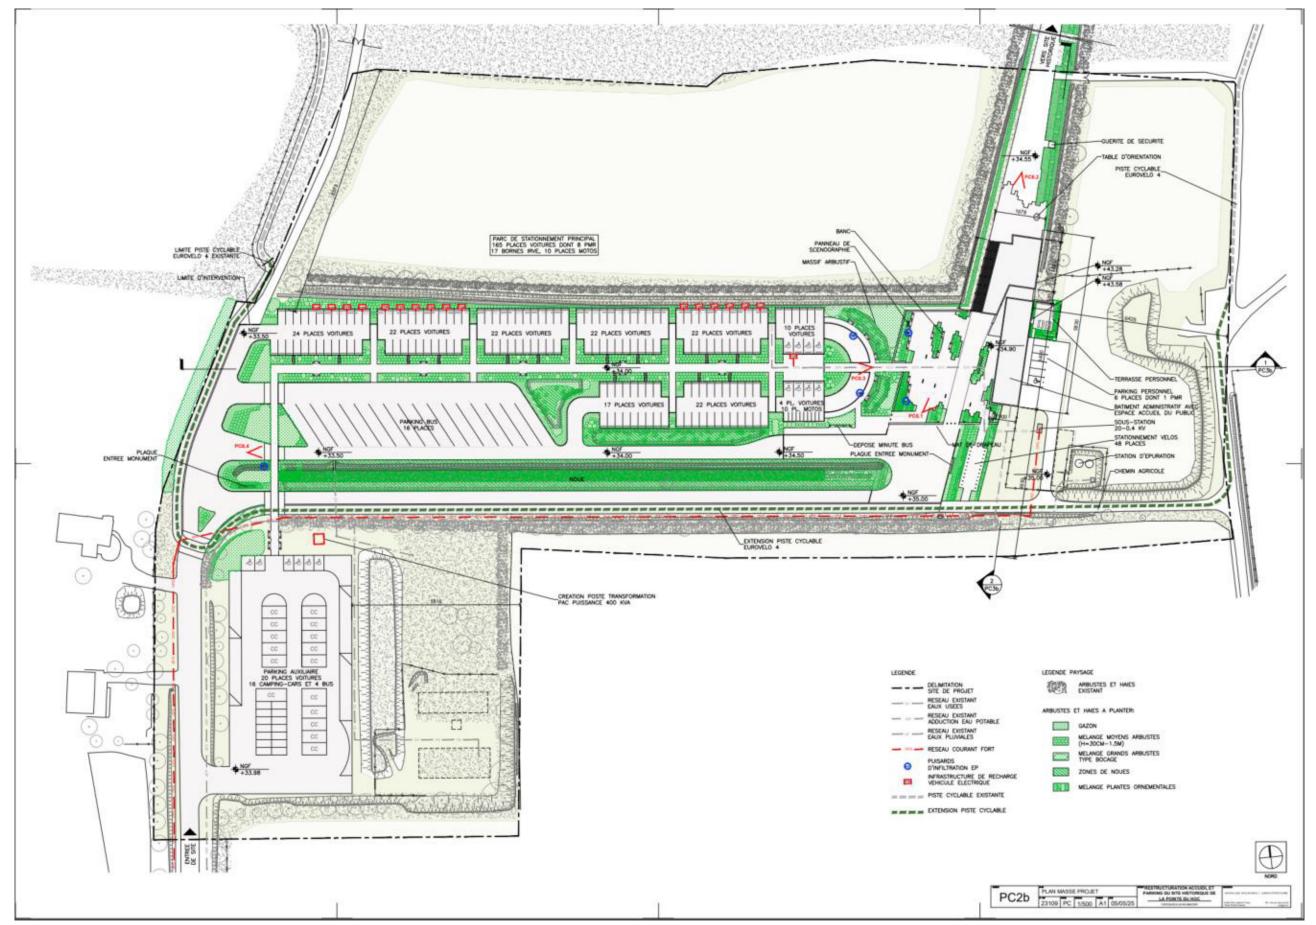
Plan de masse du projet de réaménagement de la zone d'accueil (parking, voirie, bâtiment)
